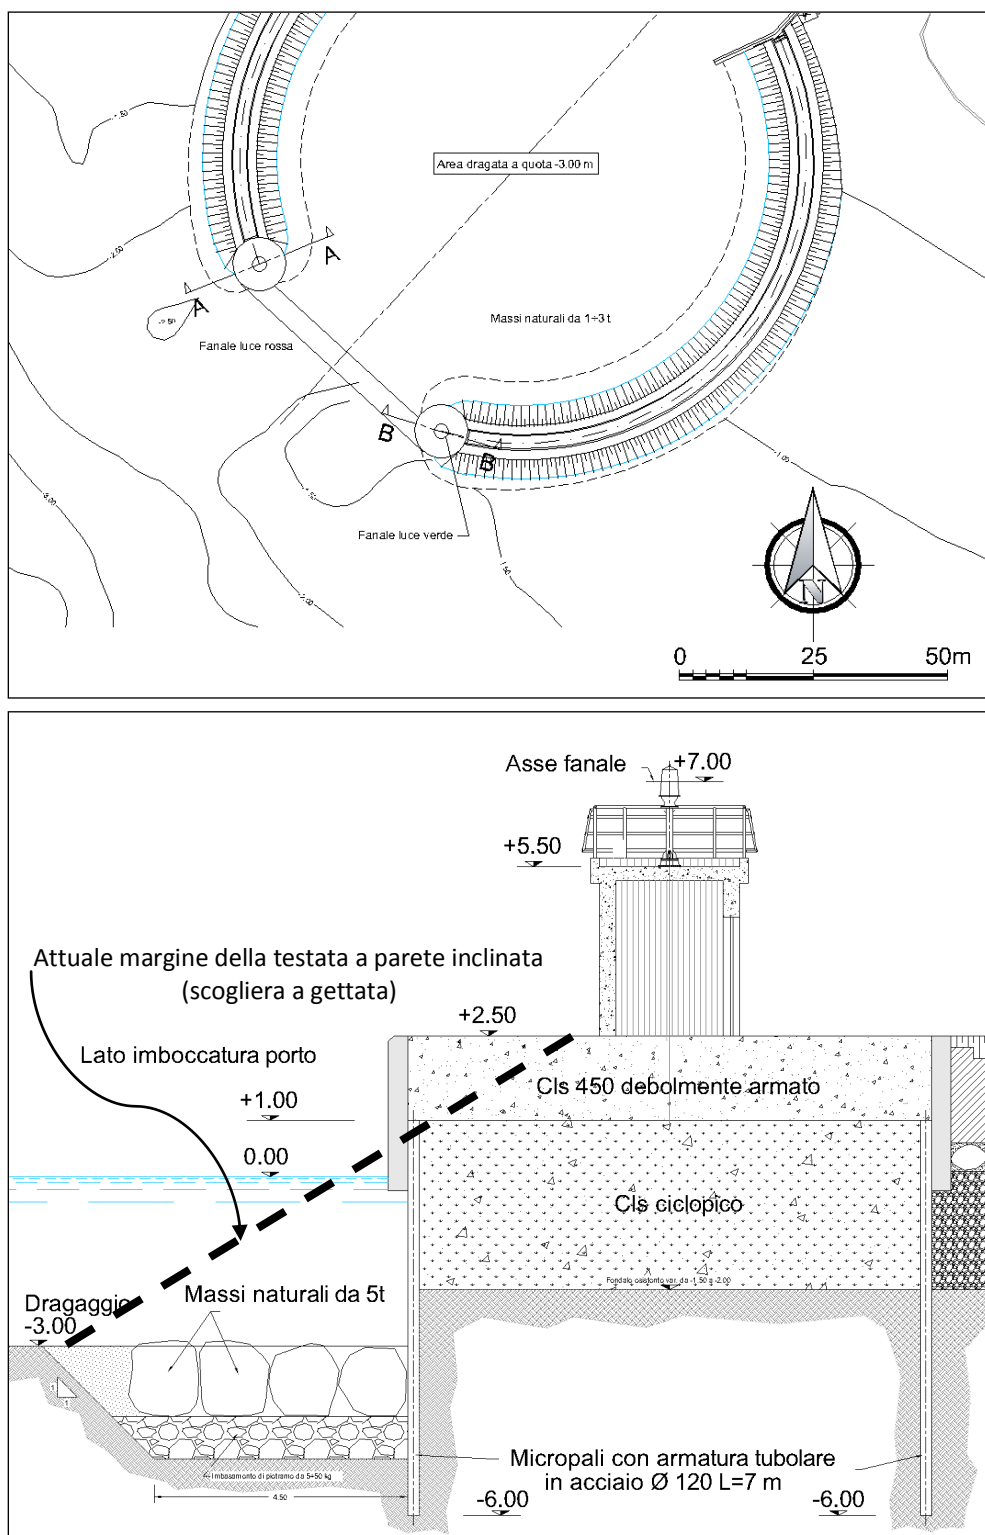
Planimetria e sezione tipo dell'adeguamento tecnico funzionale delle testate di estremità dei moli foranei dello sbocco a mare del Canale di Rio Martino
